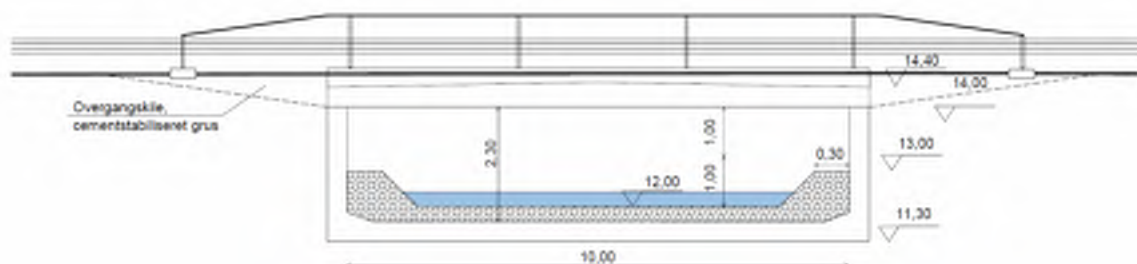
Betonelementtunnel fra Perstrup ved Kastbjerg Å, etableret i 2016.
